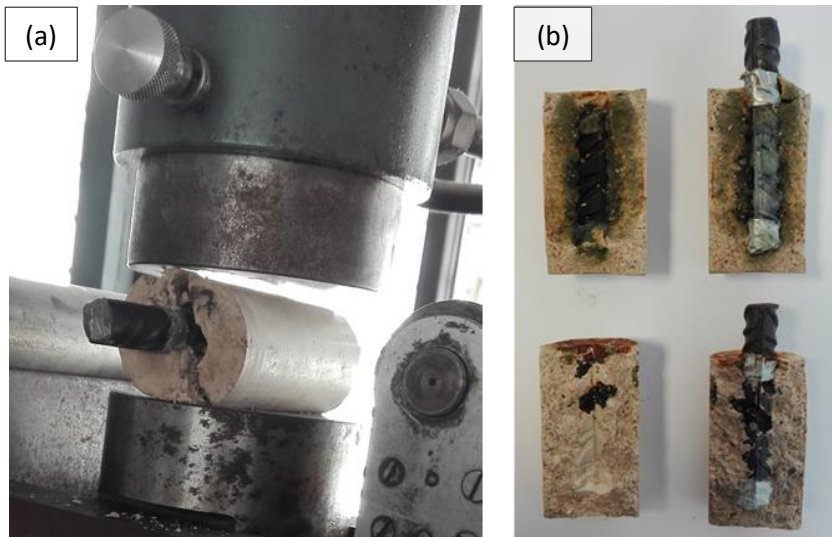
Rotura de muestras por tracción indirecta (a) e inspección del estado de las armaduras embebidas (b).
